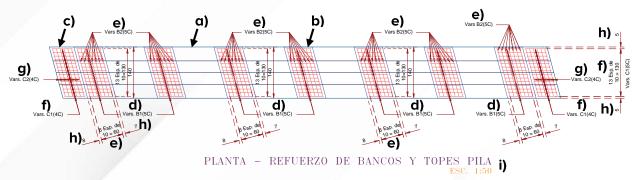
Ejemplo de planta del refuerzo de bancos y topes de pila
